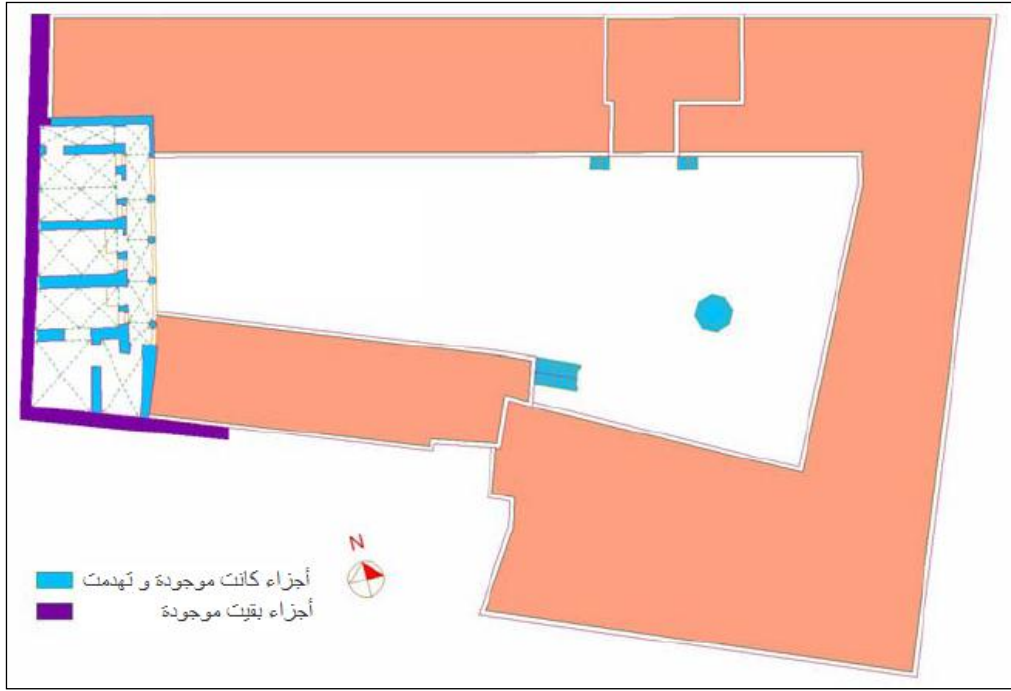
مخطط تصوري لما كان عليه الطابق الأرضي.¹³⁴
